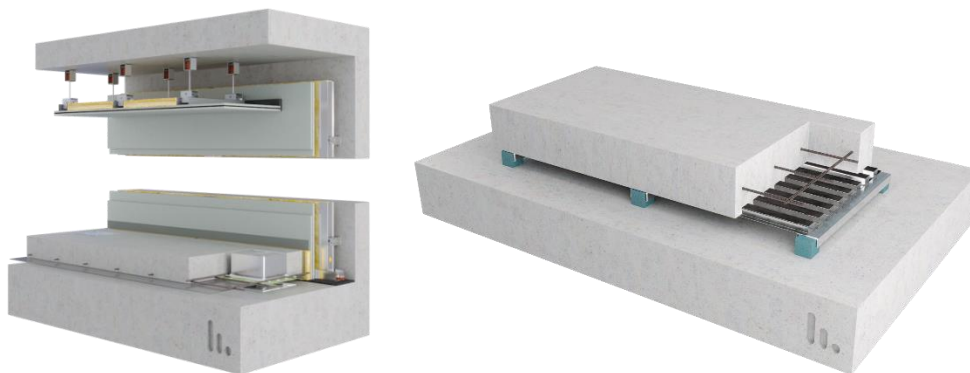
Sistema de isolamento tipo box-in-boxe de pavimento com suportes discretos em blocos elastoméricos – Stravifloor Deck.
